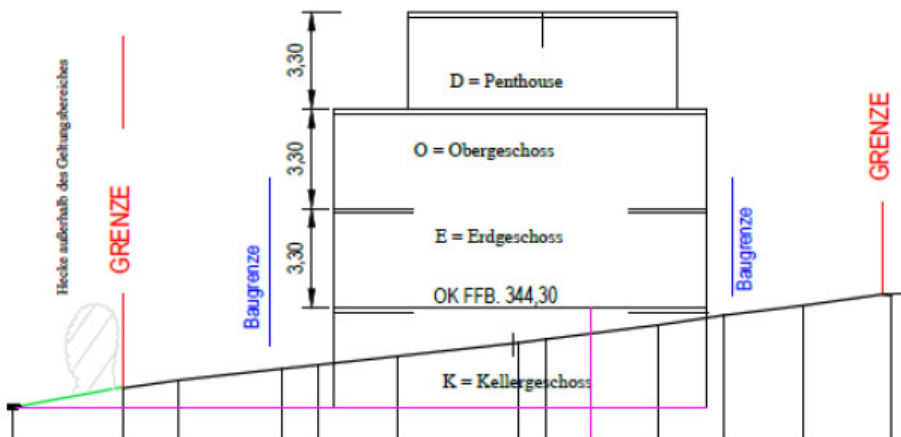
Detail aus Schnitt A – A aus dem Bebauungsplan, siehe Titelbild. Zur Verfügung gestellt von Ing.büro Eichler.
